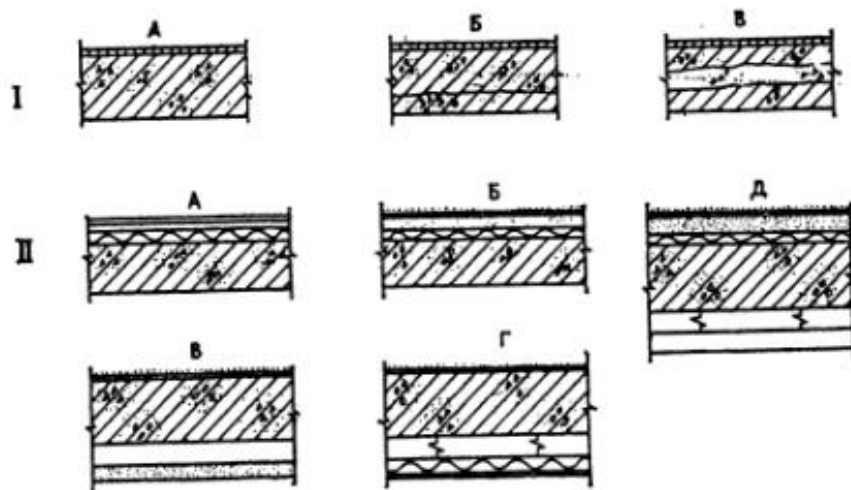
Принципиальные схемы звукоизоляции междуэтажных перекрытий: I - акустически однородные перекрытия; А, Б и В - по одно-, двух- и трёхслойным железобетонным панелям; II - акустически неоднородные; А - со слоистым полом; Б - с отдельным полом; В - с отдельным самонесущим потолком; Г - с отдельным подвесным потолком; Д - с отдельным полом и потолком
